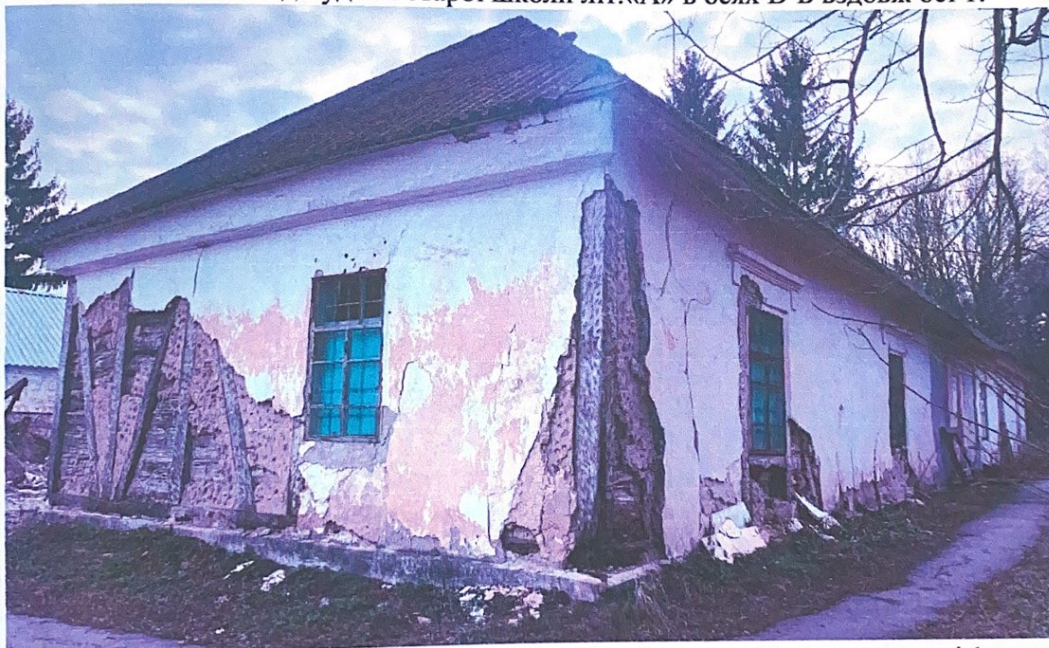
Фасад будівлі старої школи літ.«А» в осях В-А, вздовж осі 1.
